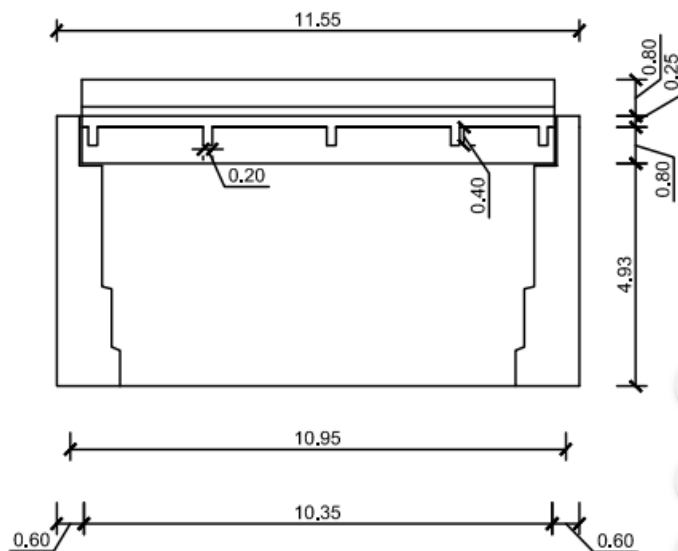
Corte longitudinal da ponte. Fonte: DNIT (2019)
